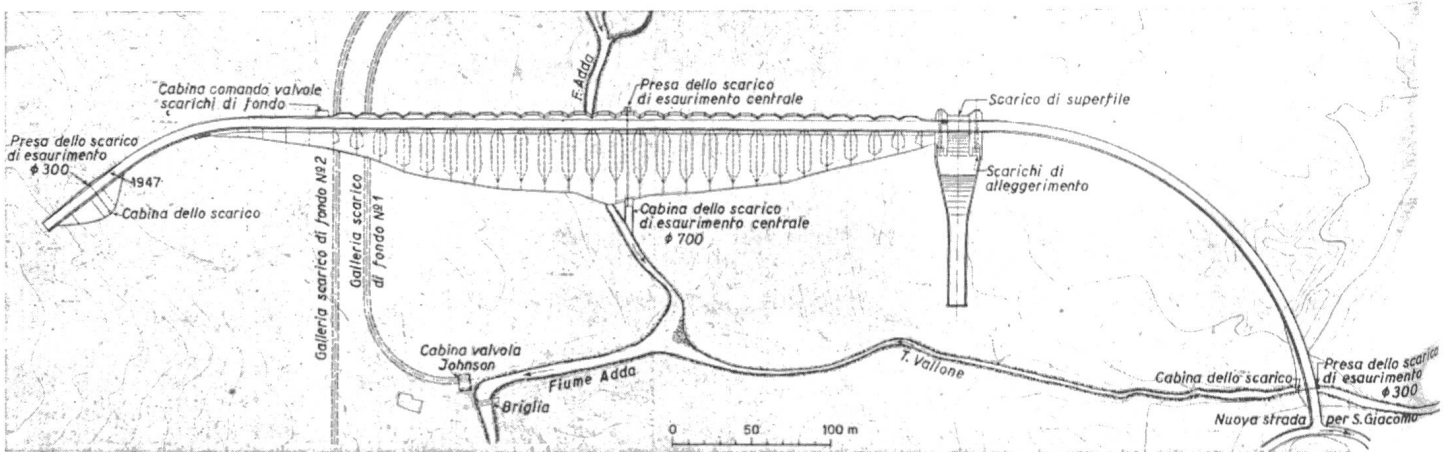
Lageplan der Staumauer S. Giacomo di Fraele, 1:5000.
